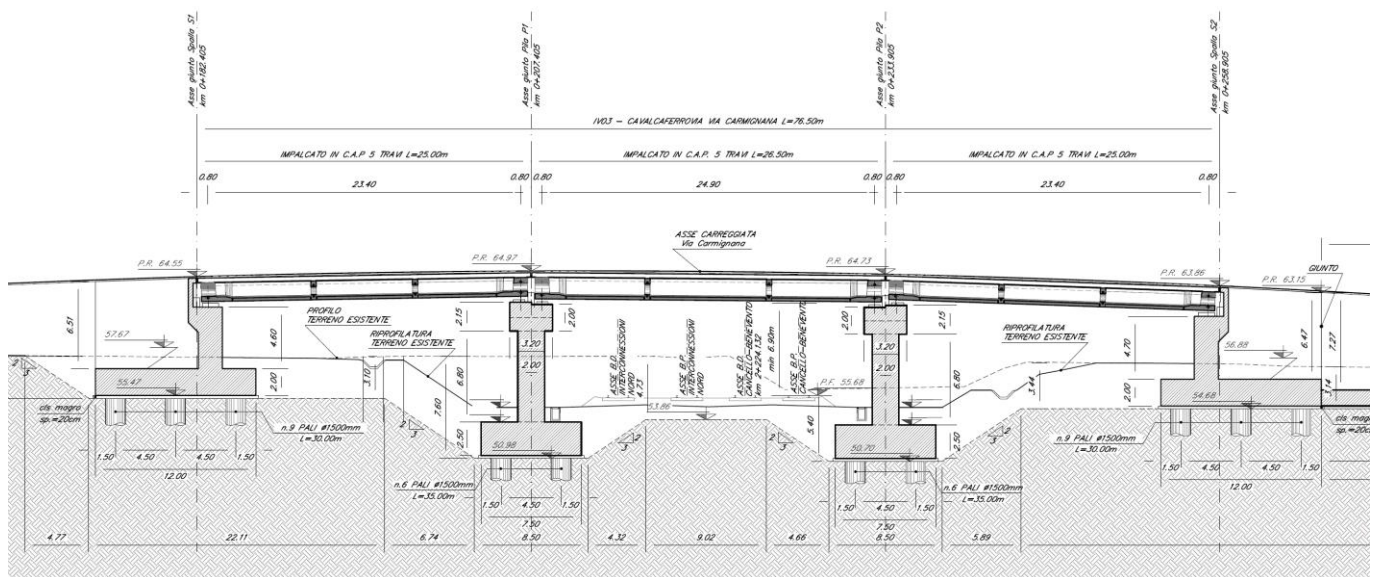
Sezione longitudinale del Cavalcaferrovia
